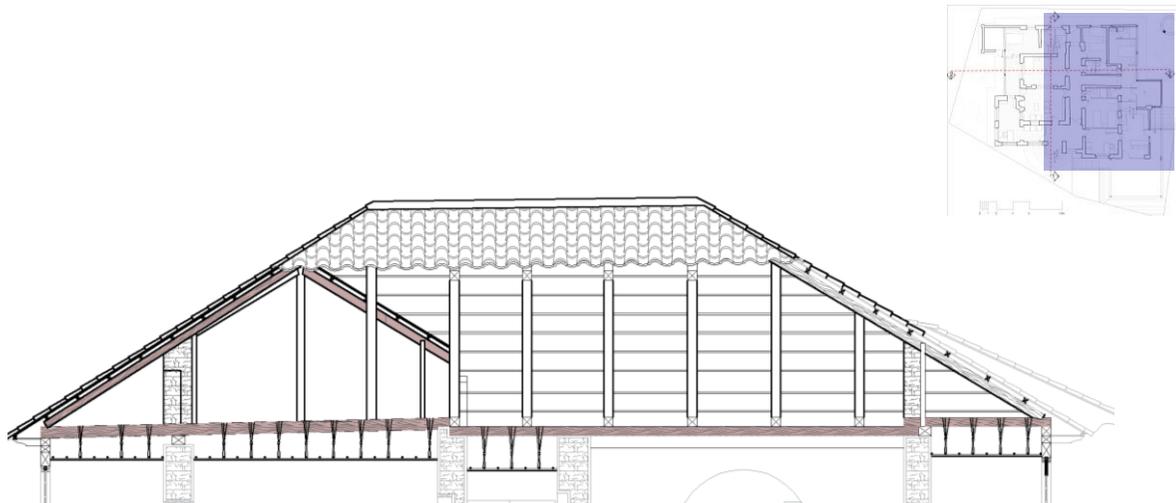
Cubierta de madera vista en corte longitudinal Fuente: Elaboración propia
